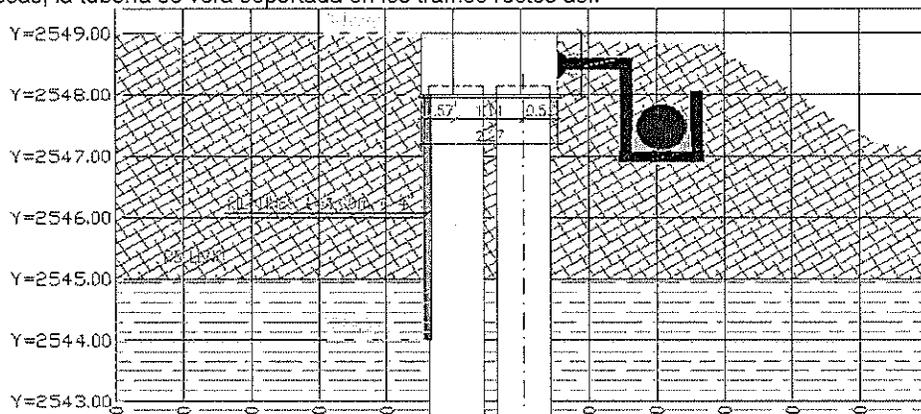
Corte Transversal del Conjunto Muro Pantalla y Soporte de Tubería en tramos rectos.
